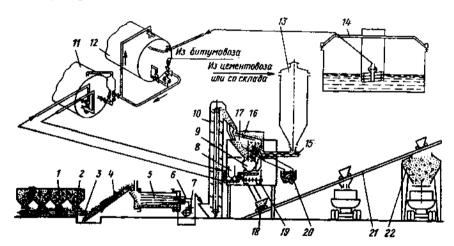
Технологическая схема приготовления асфальтобетонной смеси: 1 — бункера агрегата питания; 2 — питатели; 3 — ленточный конвейер; 4 — наклонный конвейер; 5 — сушильный барабан; 6 — форсунка; 7 — вентилятор: 8 — дозатор битума; 9 — весовой дозатор заполнителей; 10 — элеватор; 11 — битумоплавильня; 12 — емкость для битума; 13 — бункер минерального порошка; 14 — битумохранилище с нагревательно-перекачивающим агрегатом; 15 — шнек-дозатор; 16 — горячий грохот; 17 — расходный бункер; 18 — скип; 19 — смеситель; 20 — бункер излишков и щебеночного негабарита; 21 — скиповый путь; 22 — накопительный бункер
